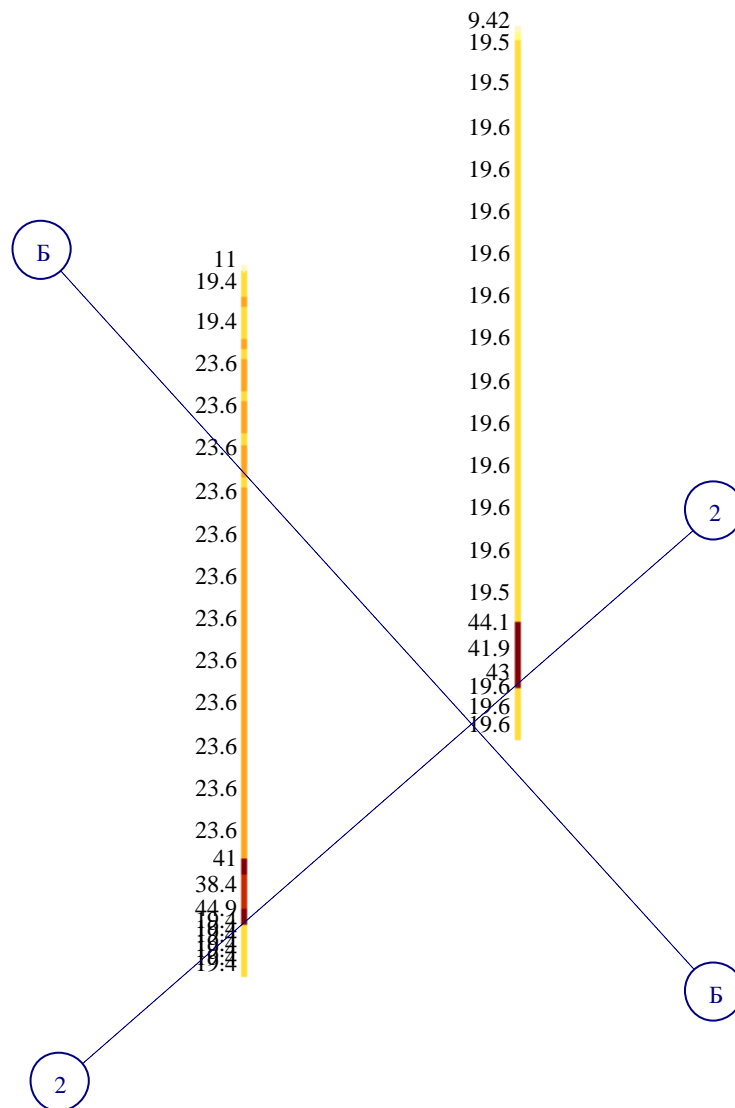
Площадь армирования колонн осей А/2 и Б/2 при эксплуатационных нагрузках
